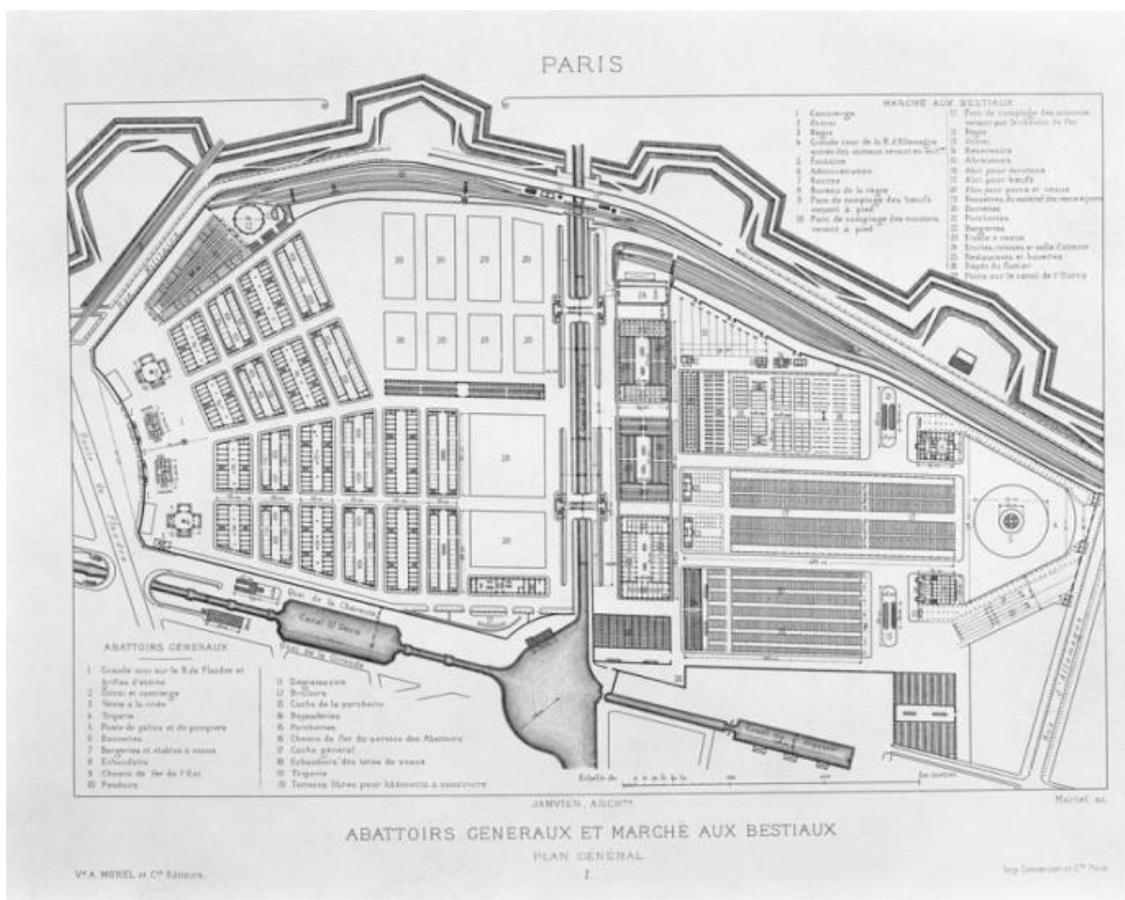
Planta do Abatedouro de Paris - Arquiteto Louis Janvier
